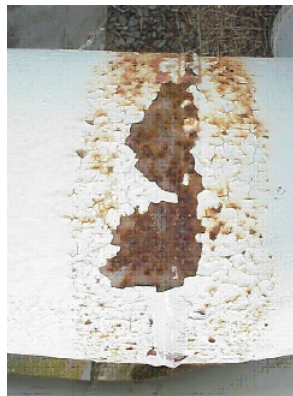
Corrosión en uniones soldadas [40].
